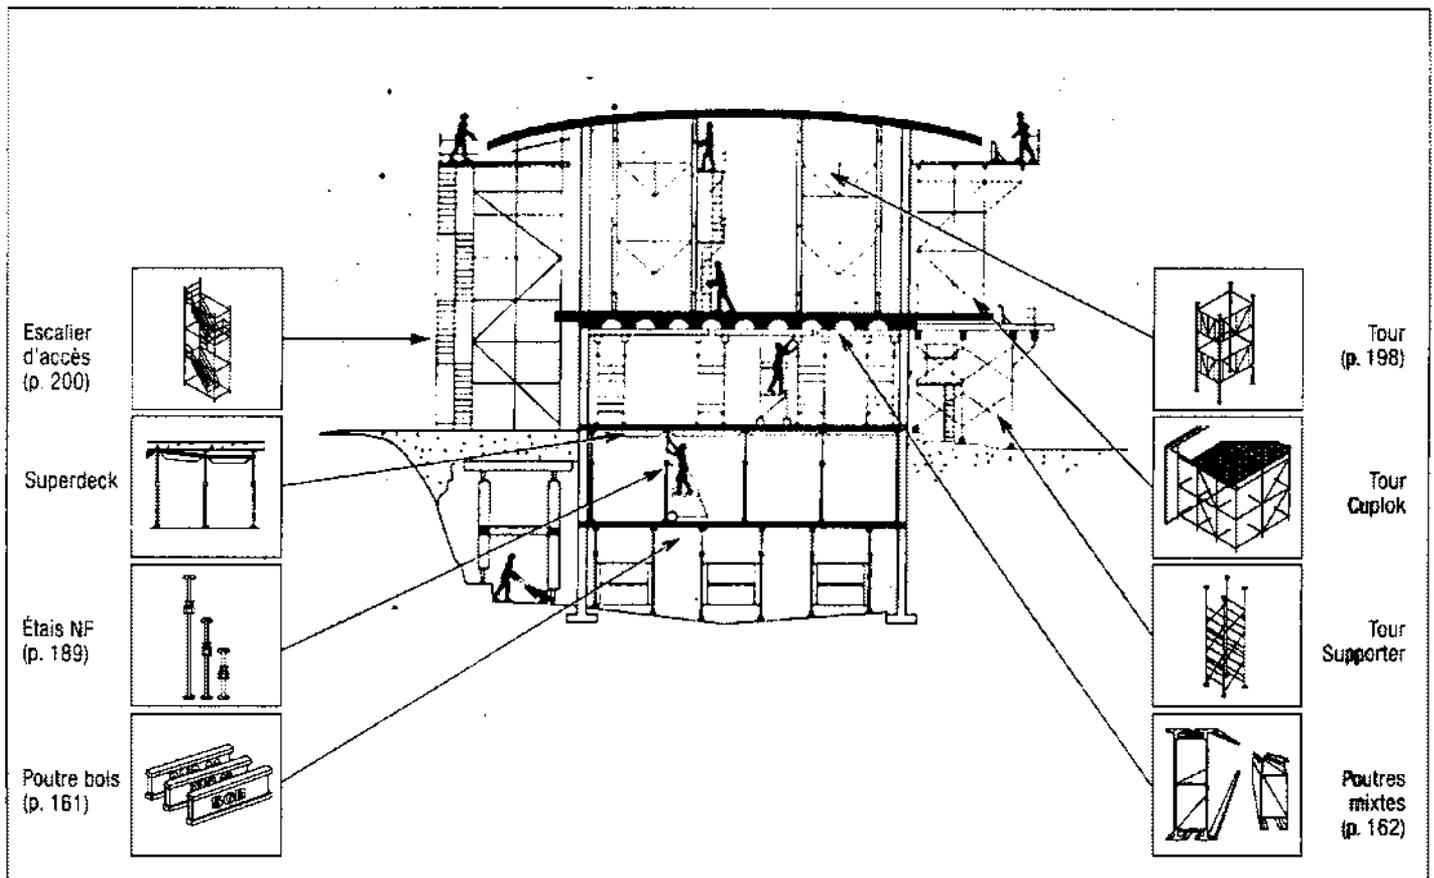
Techniques de coffrage des dalles (doc. S.G.B. - J.M. Bastitella).
